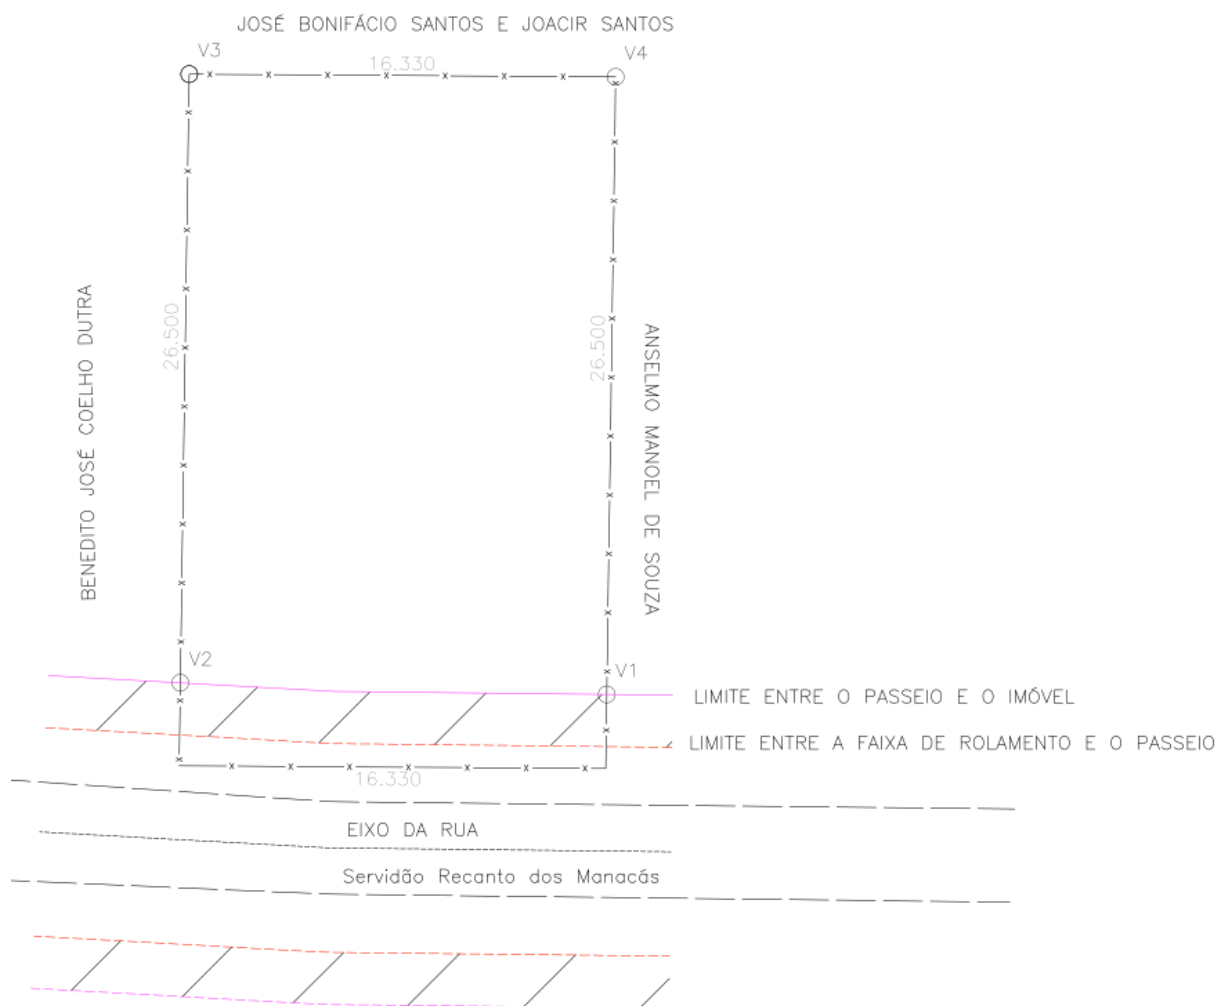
Planta de um imóvel e o sistema viário proposto no Plano Diretor
